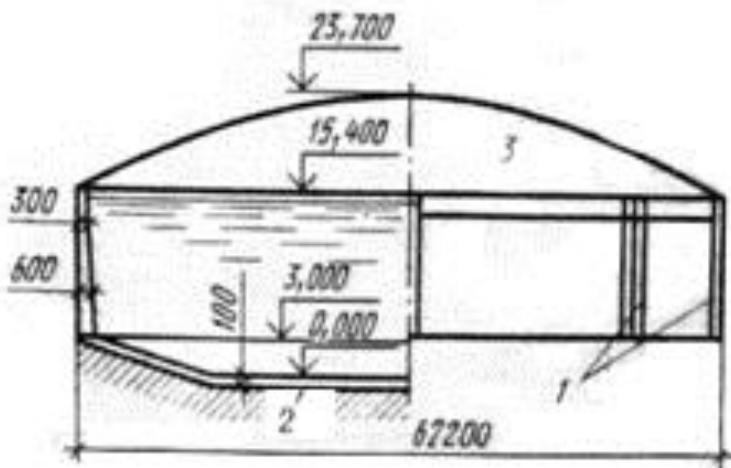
Конструктивное решение круглого монолитного резервуара: 1 – стенка резервуара, 2 – днище; 3 – покрытие
